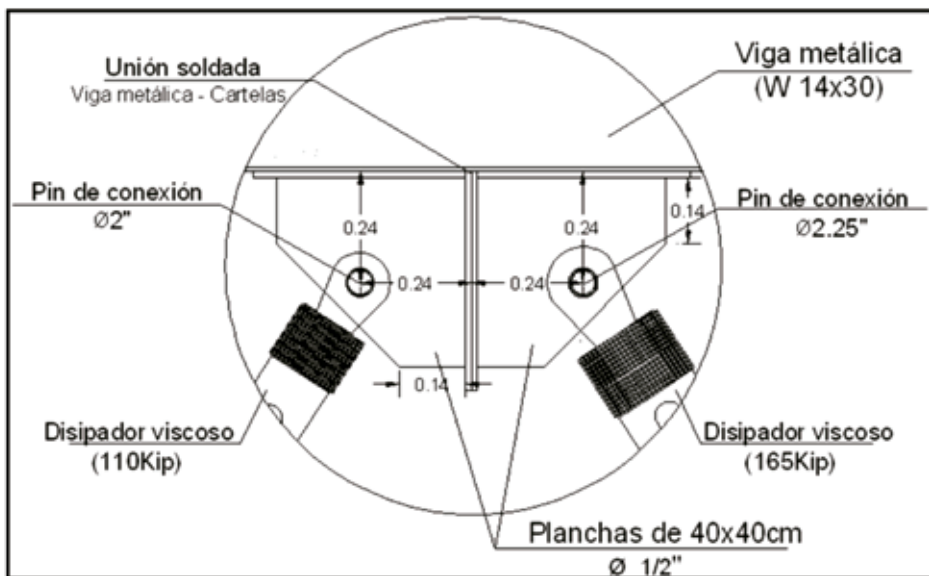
DETALLE 1: UNIÓN DISIPADORES CON LA VIGA DE ACERO
